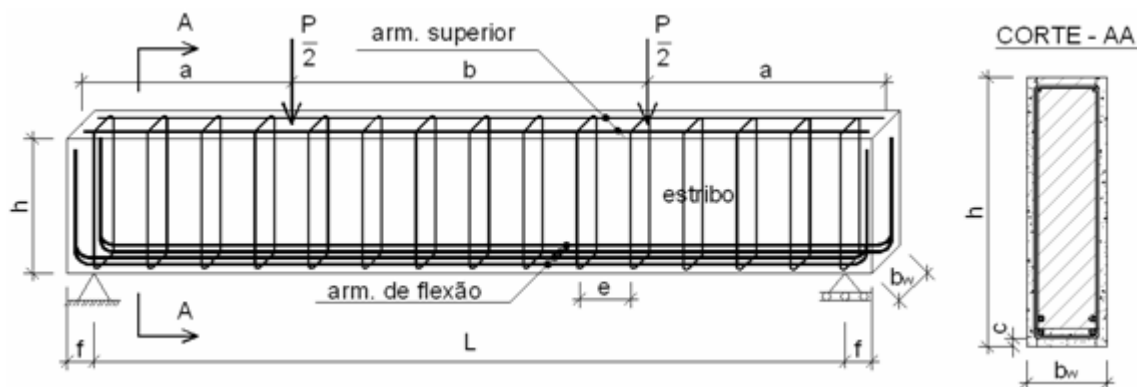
Detalhe da armadura, apoios e carregamento (SILVA FILHO et al., 2006)
